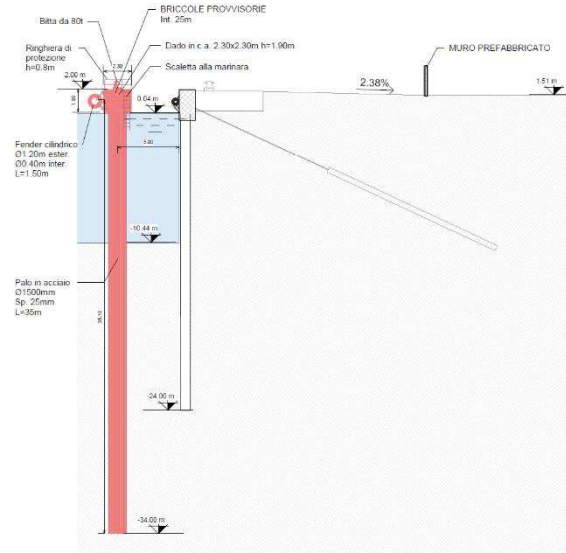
Sezione con indicazione delle briccole provvisorie da installare.
